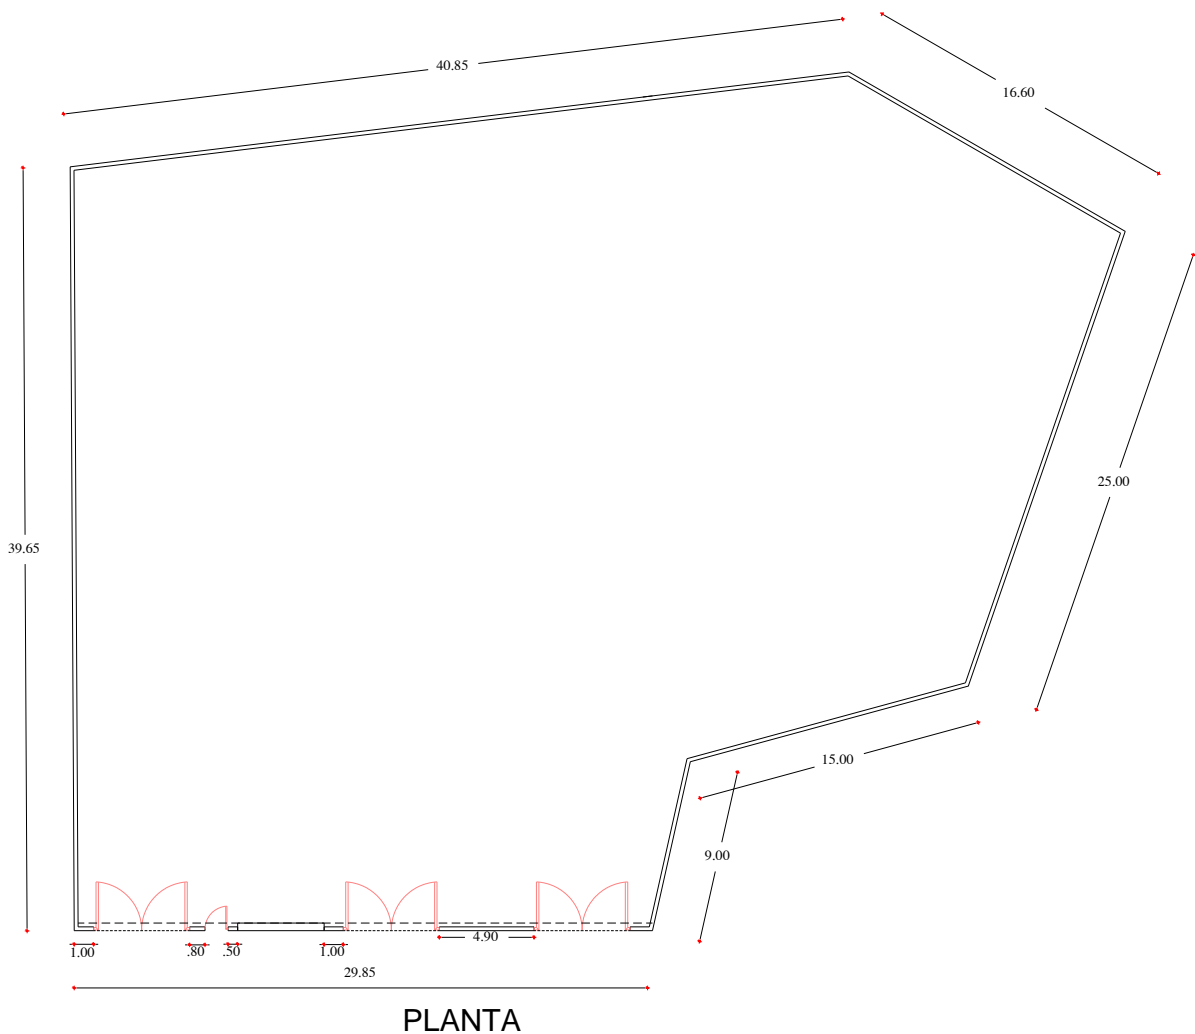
Vista en planta del lugar por cubrir. (Ver Anexos).
